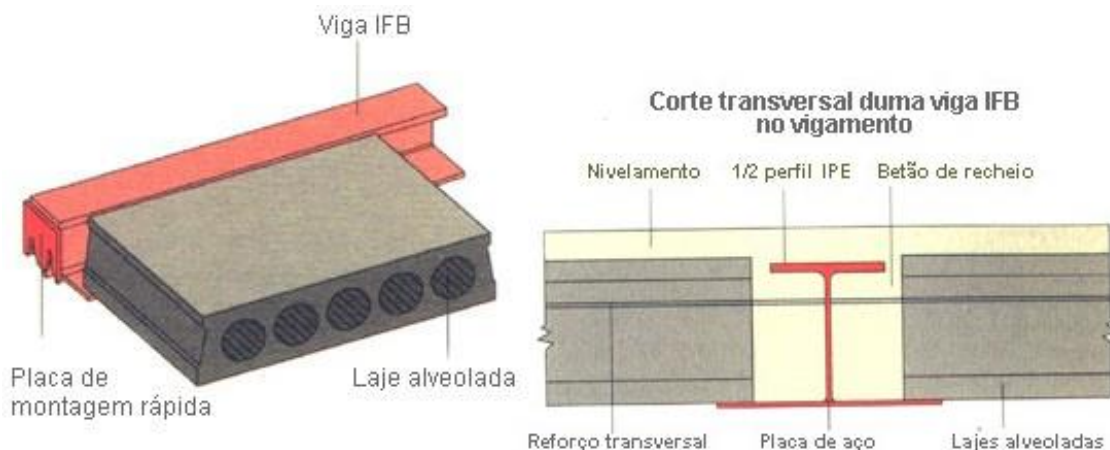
Detalhe de vigamento com estrutura de vigas IFB (embebida no vigamento).
